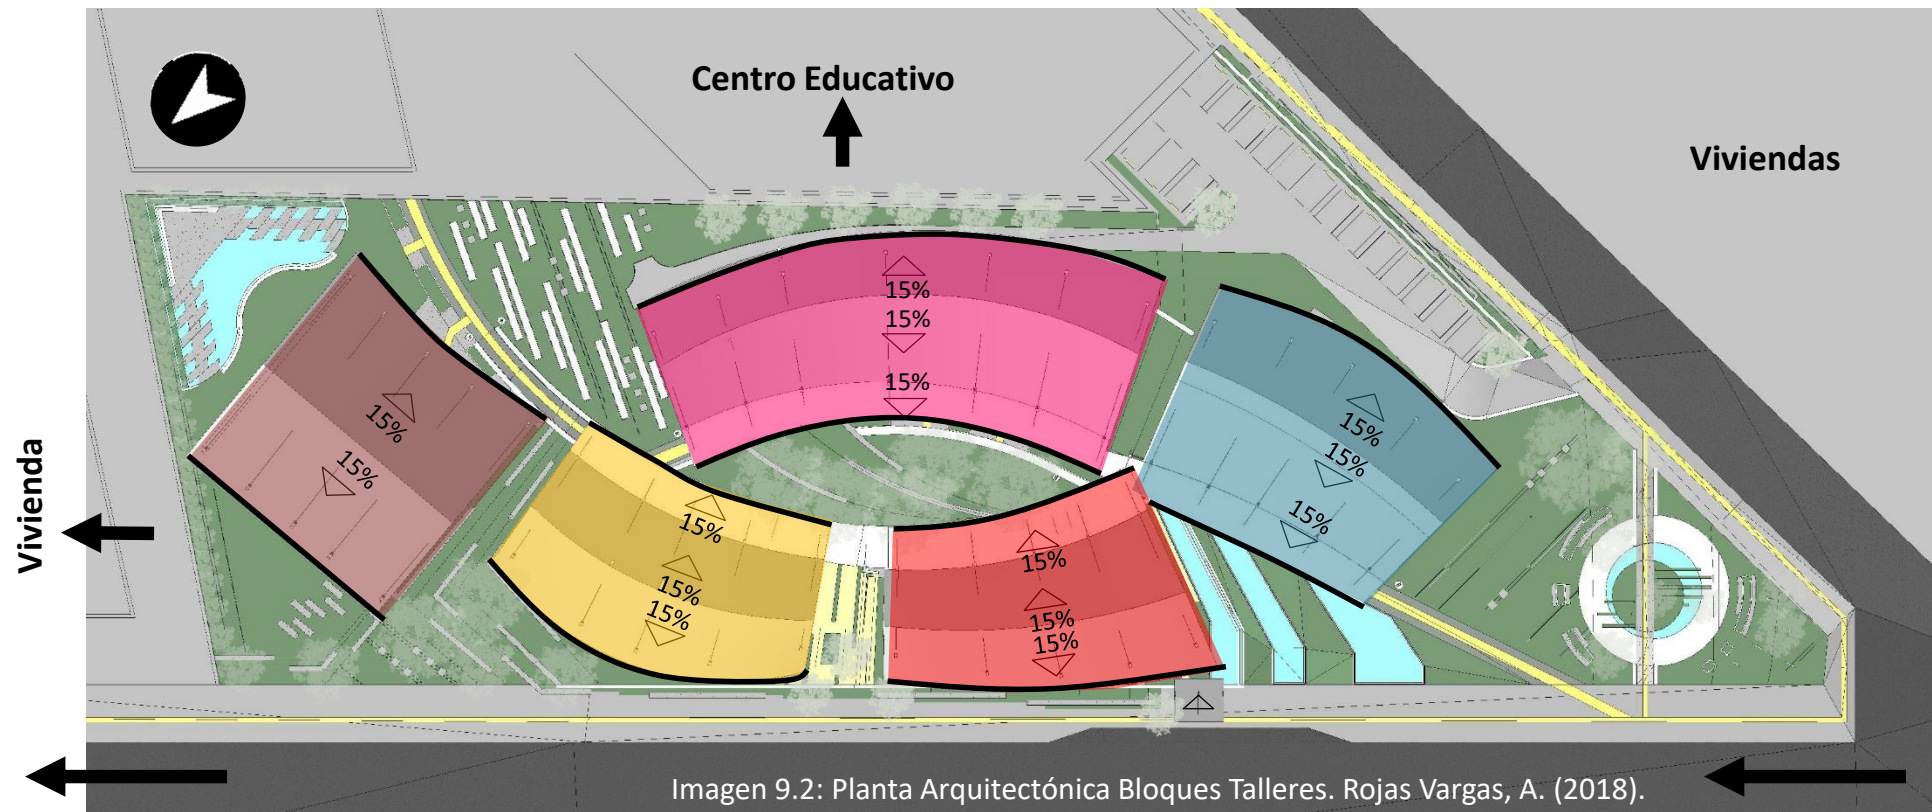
Planta Arquitectónica Bloques Talleres. Rojas Vargas, A. (2018).
